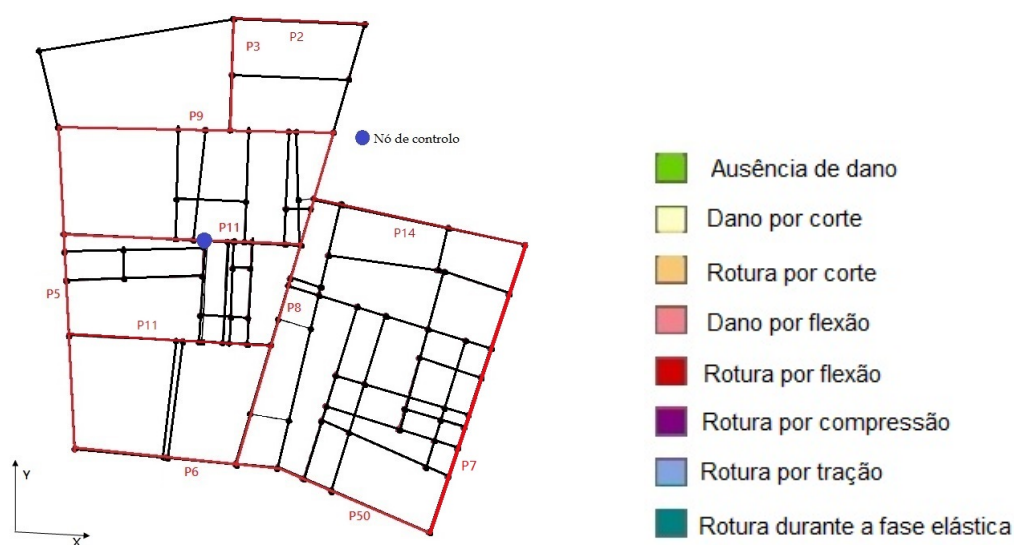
Planta do 3º piso, com indicação das paredes analisadas
